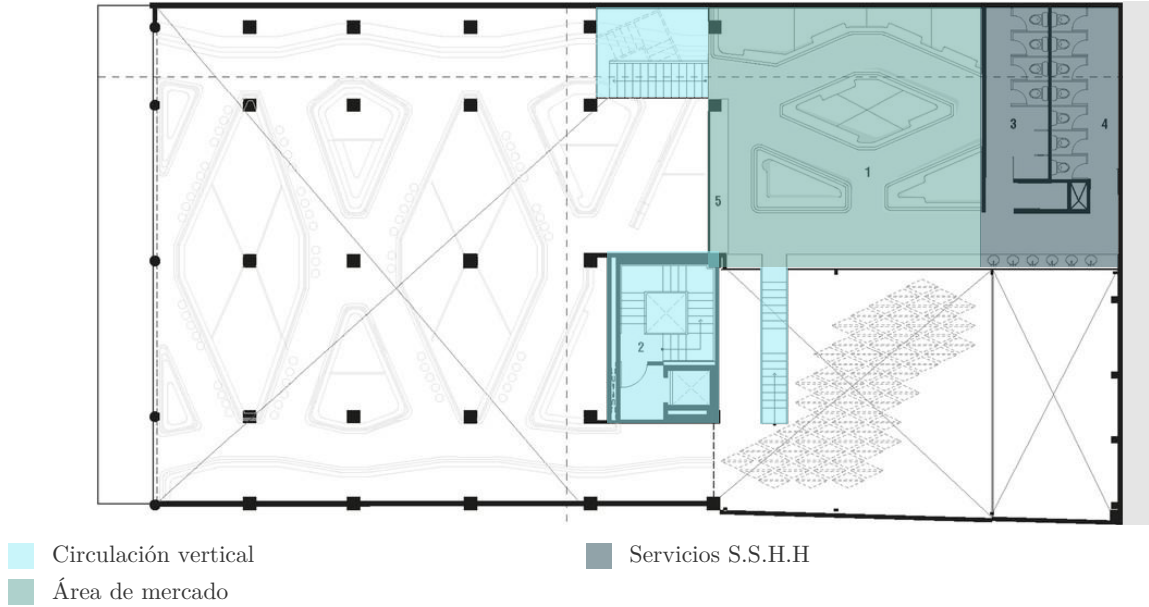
Planta Mezzanine Mercado Roma. Elaborado: Autores.
